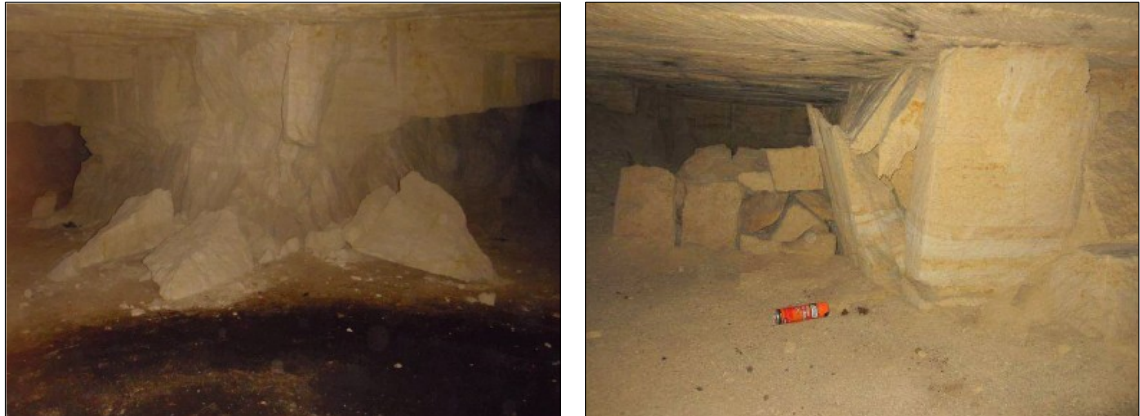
Fissuration d'un pilier « en diabolo » (à gauche) et pilier ruiné (à droite) dans les carrières de LATRESNE [Source : Antea Group]
